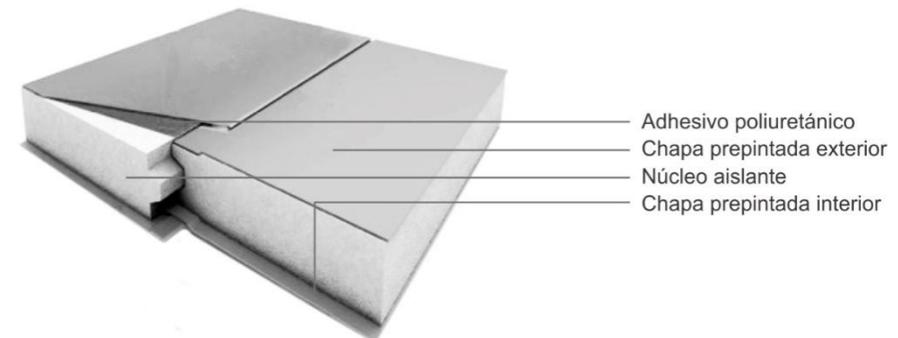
Detalle de Roof Panel (Panel de techo) "Acier"
